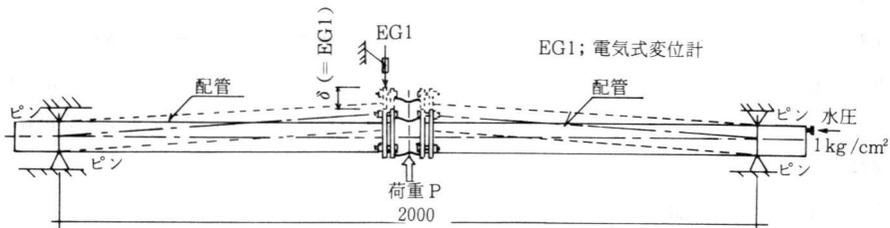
継手可とう部分曲げ試験方法 (単位 mm)
